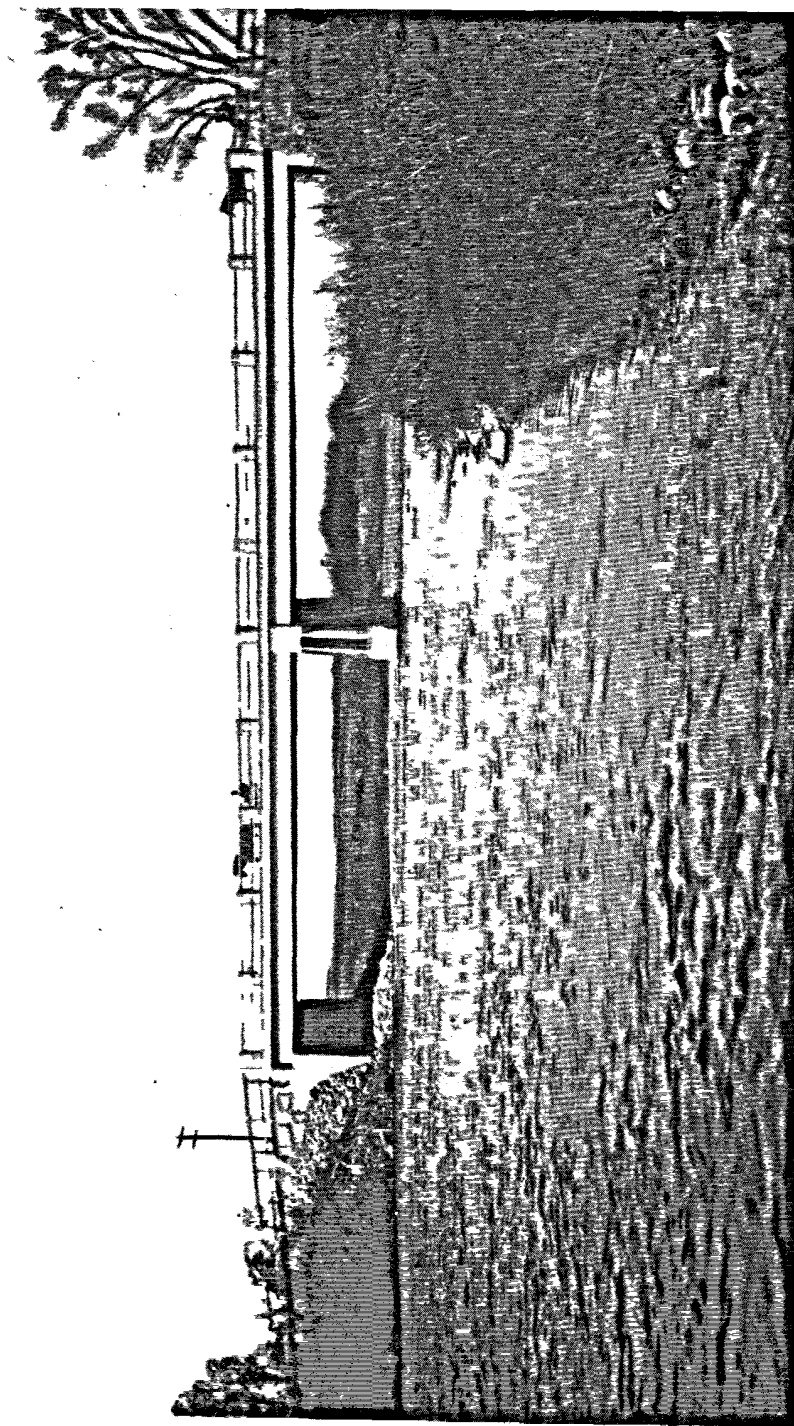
PONT "GARAND" SUR LA RIVIÈRE DU LOUP A STE-VICTOIRE, COMTÉ ARTHABASKA.—Tablier en béton armé et poutres en acier sur substruction en béton. Deux travées formant une longueur totale de 118 pieds et 6 pouces. Voie charretière de 18 pieds de largeur. Construit en 1933.
